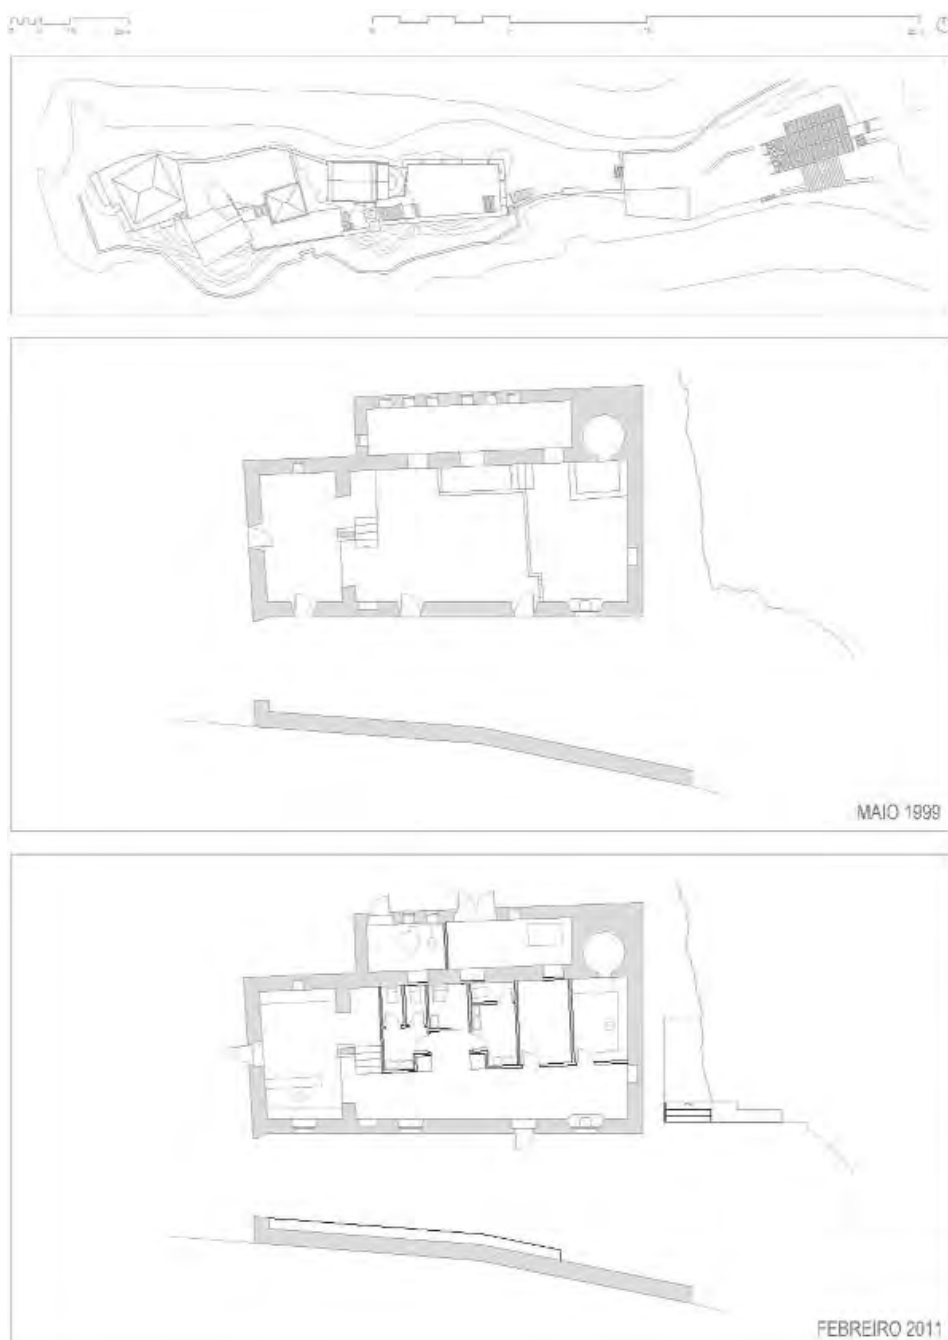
CAAVEIRO. Planta baixa da Casa dos Guardeses (Pavillón de servizos e aula).
